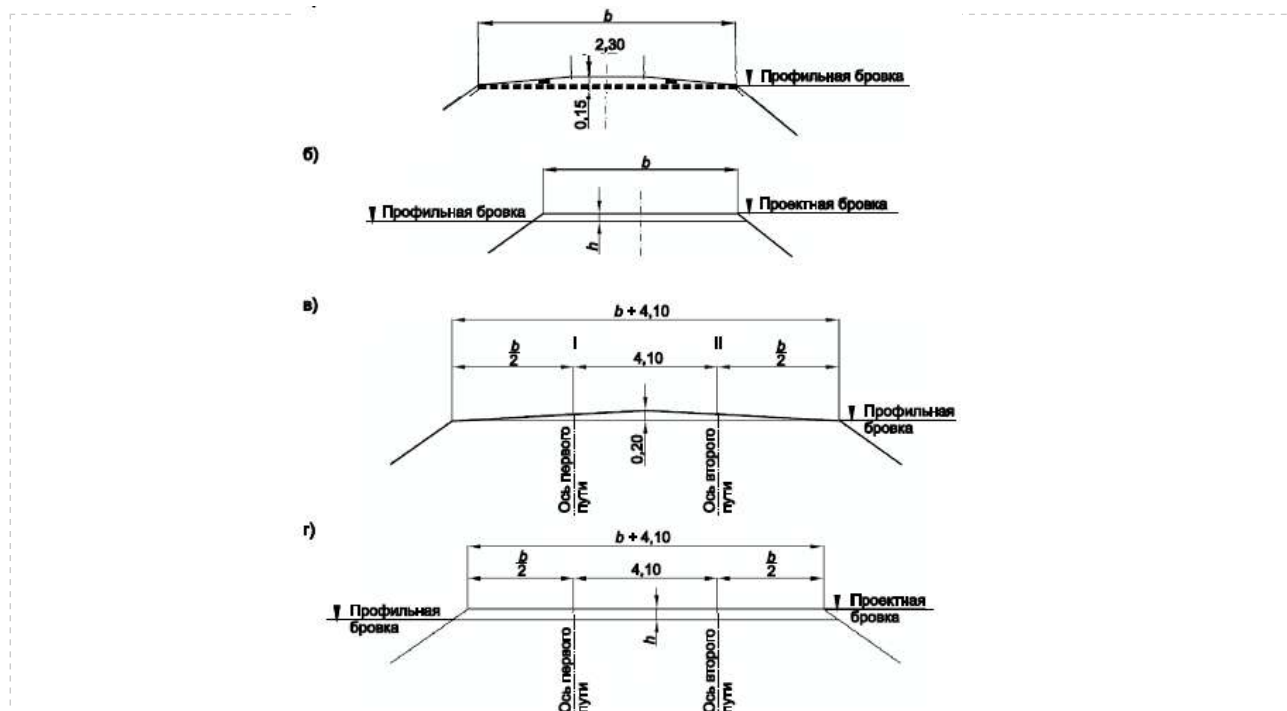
Поперечные очертания основной площадки земляного полотна на прямых участках пути на перегонах:
